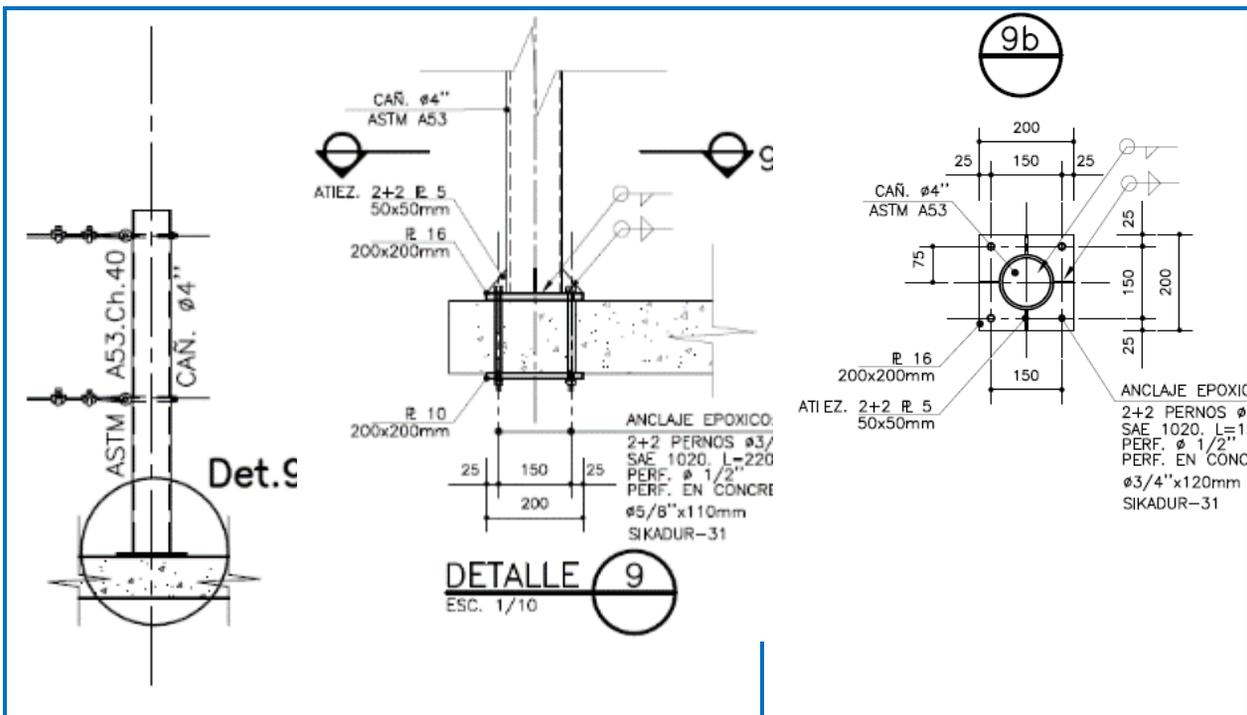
Sistema de protección conectable a un tramo terminal del tipo pilar metálico (medidas en cm)- Elaboración Propia
